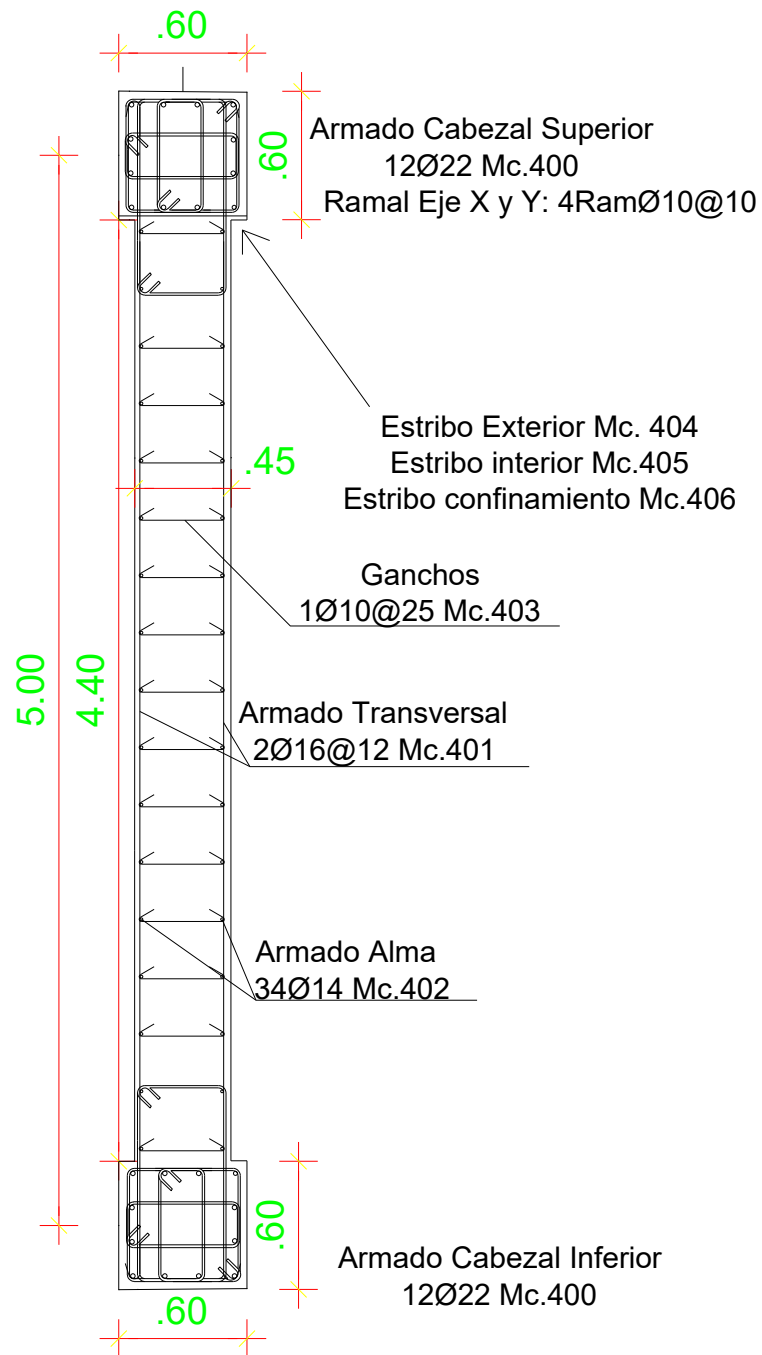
Detalle del armado de muro estructural NEC SE-HM
